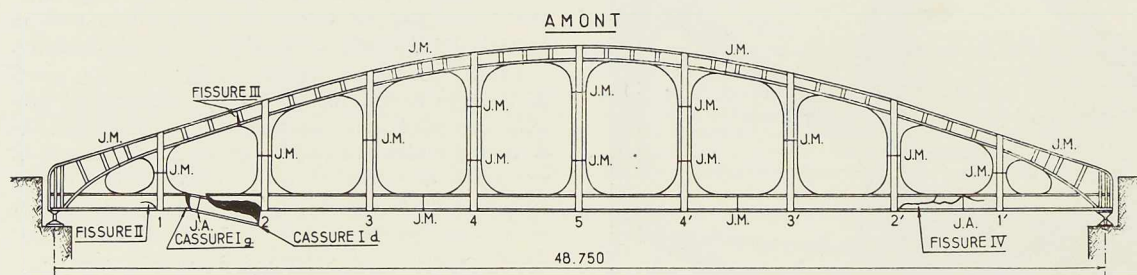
Vue en élévation de la poutre amont du pont de Kaulille.
